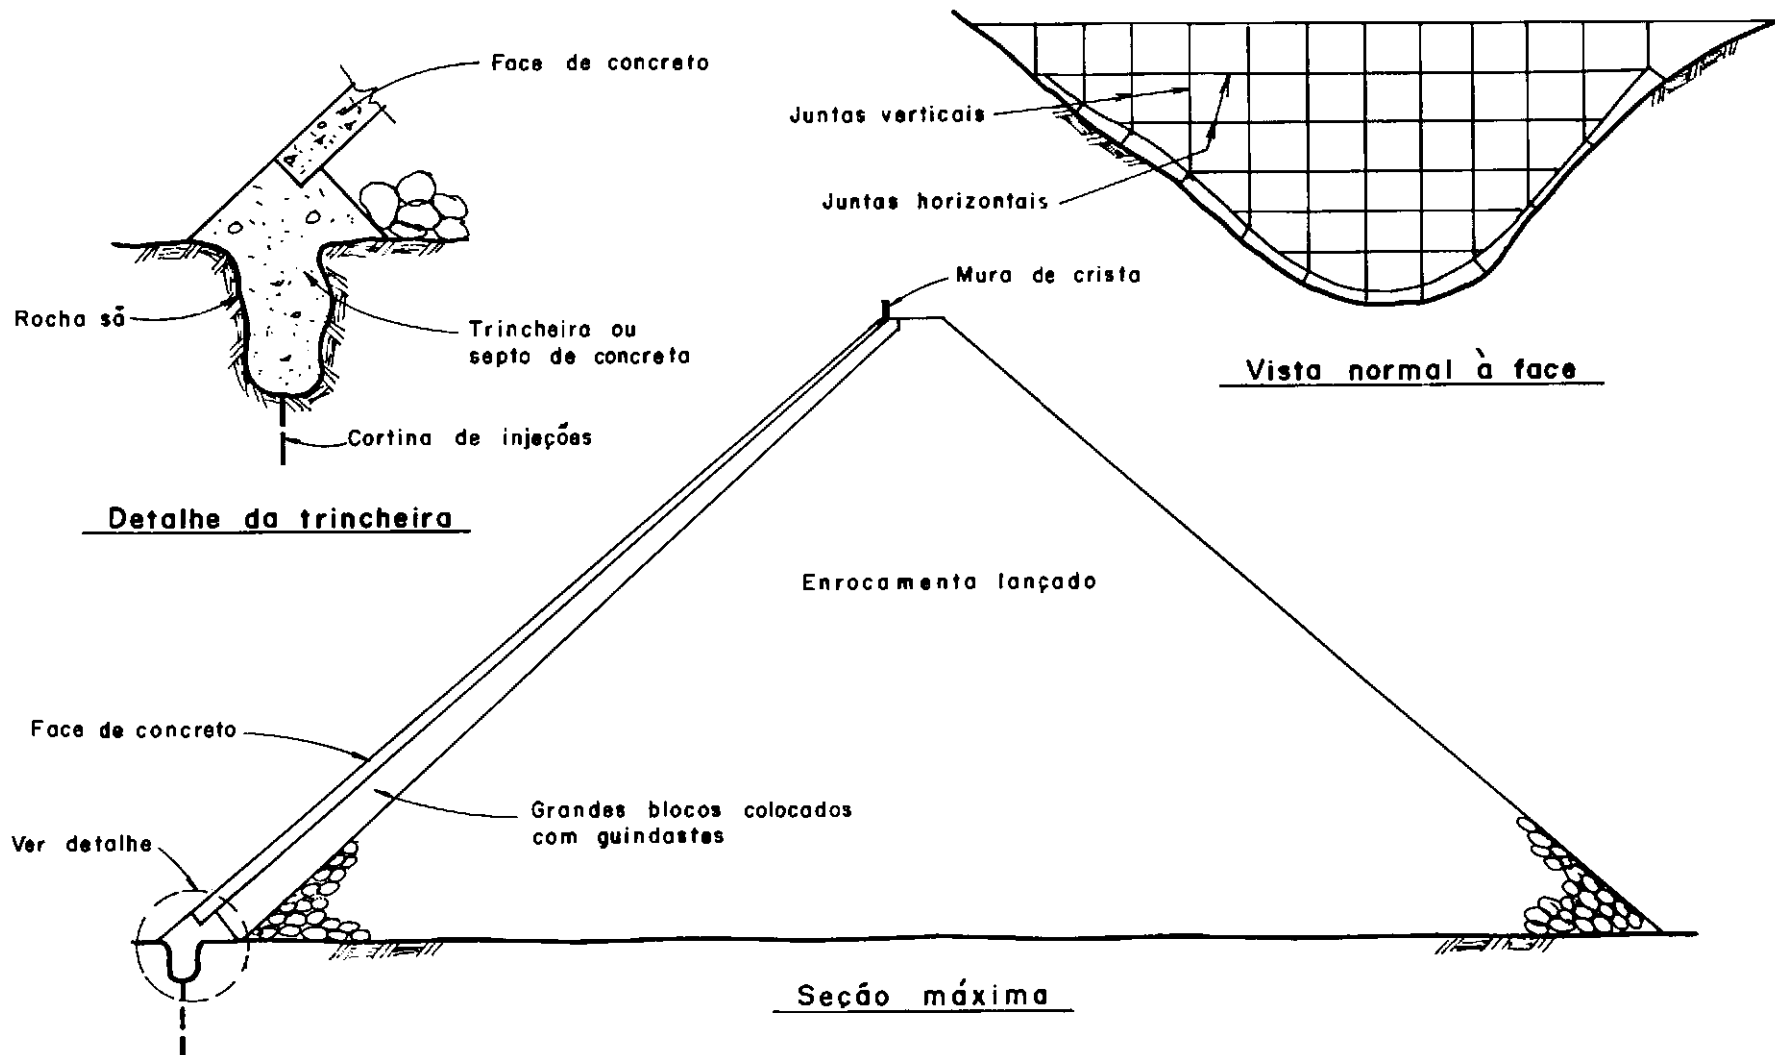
Projeto antigo da barragem de enrocamento com face de concreto.
